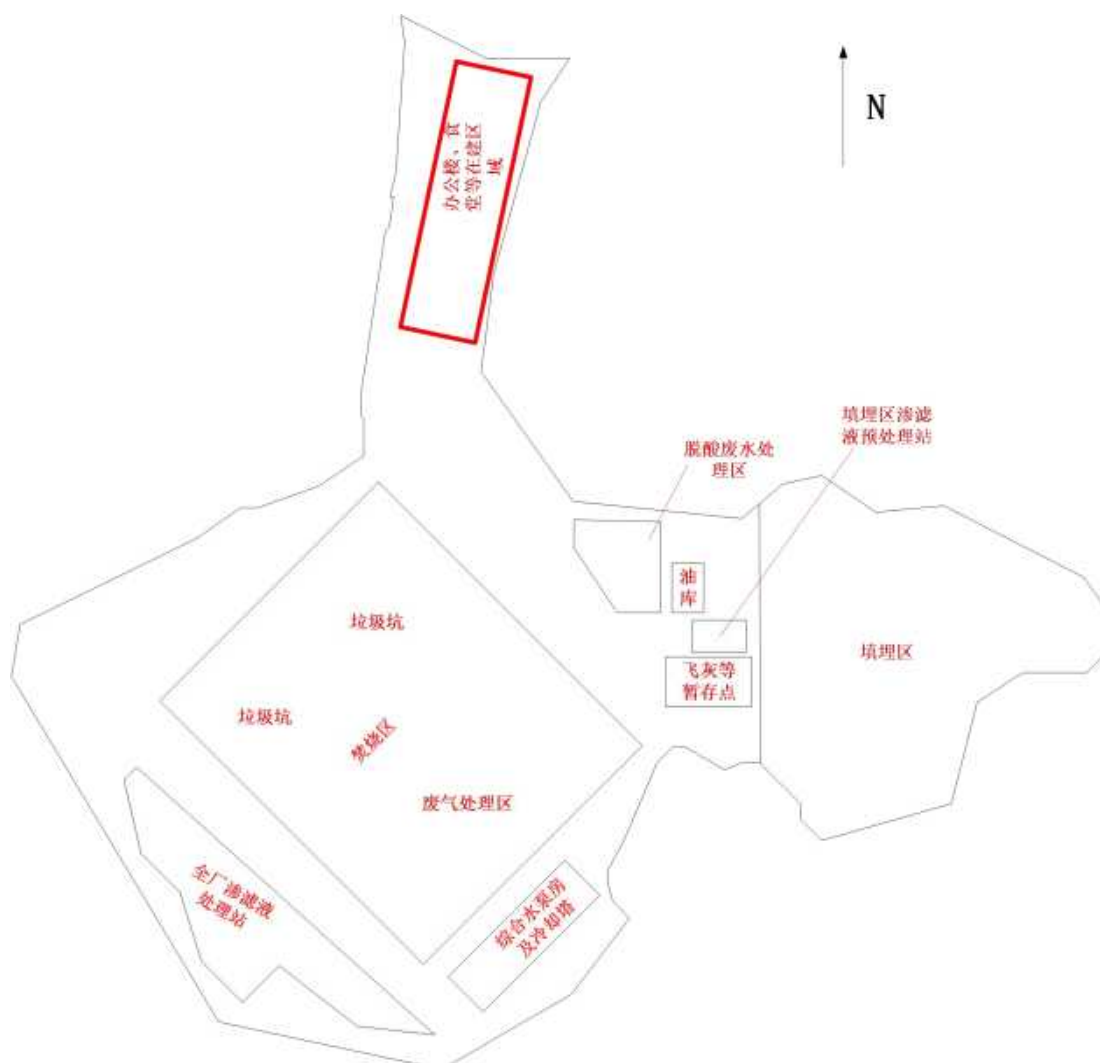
金华雅境再生能源有限公司地块平面布置图
